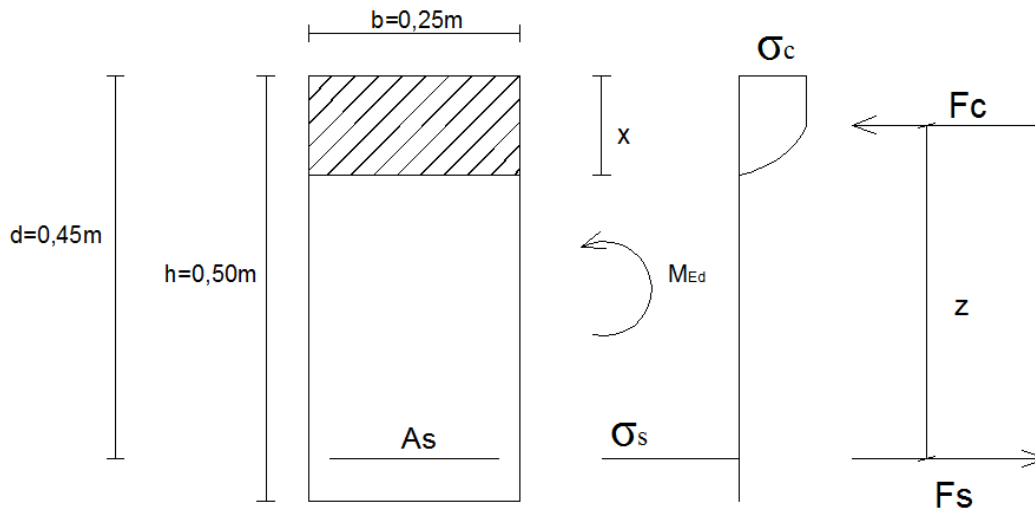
Características da secção transversal da viga, para a aplicação das equações de equilíbrio.
